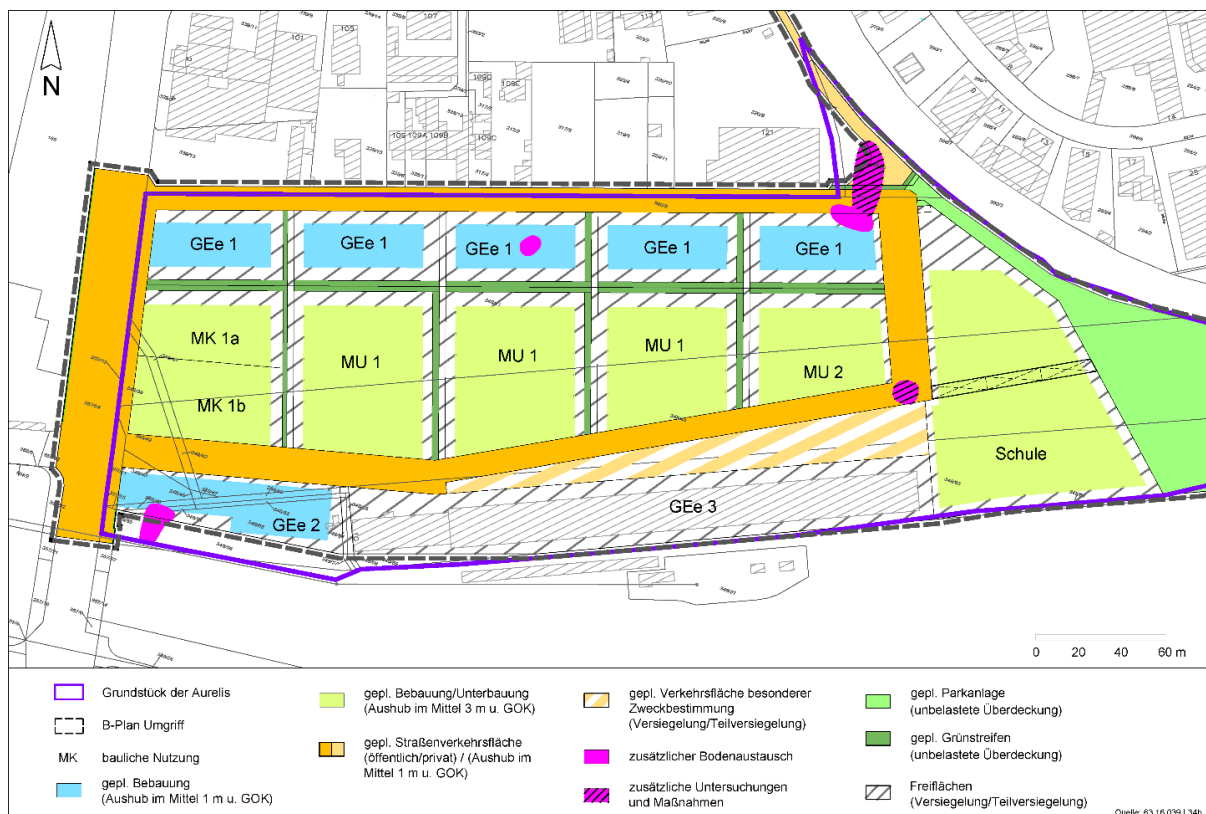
Lageplan der geplanten Maßnahmen, zusätzlicher Bodenaustausch – magenta, zusätzliche Untersuchungen und Maßnahmen – Schraffur magenta (BoSS consult 2019)
